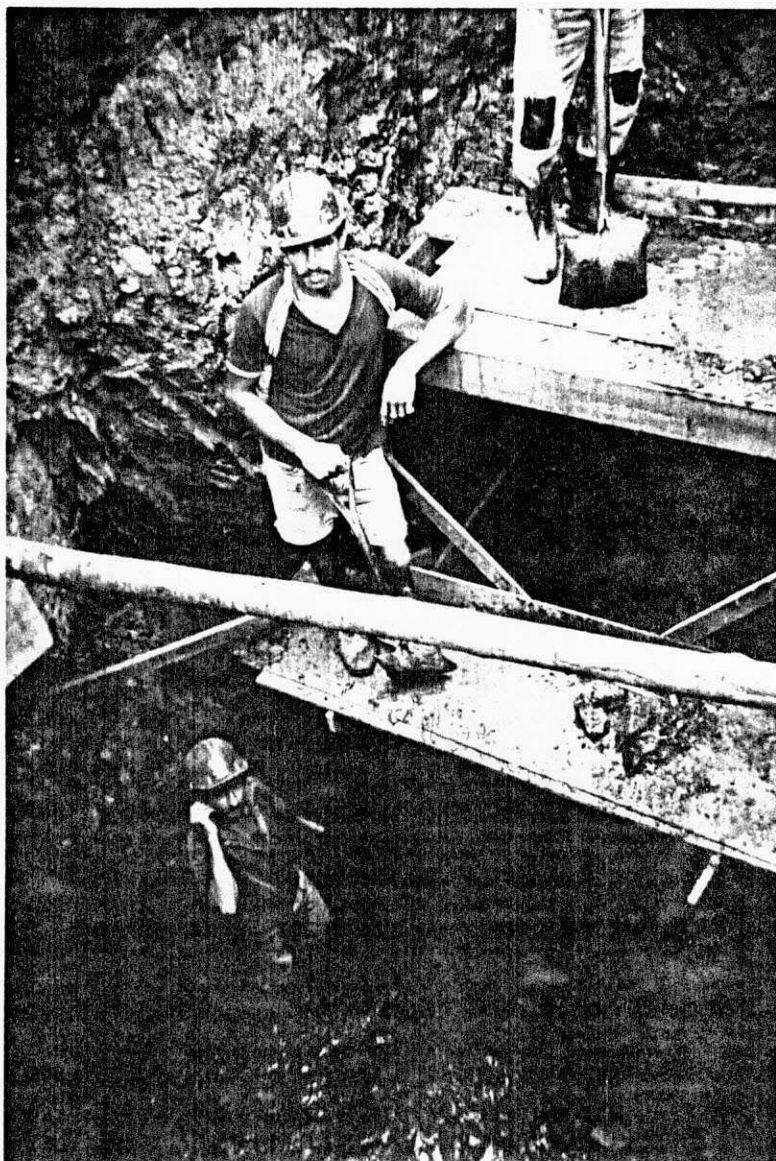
ESCAVAÇÃO DAS SAPATAS
